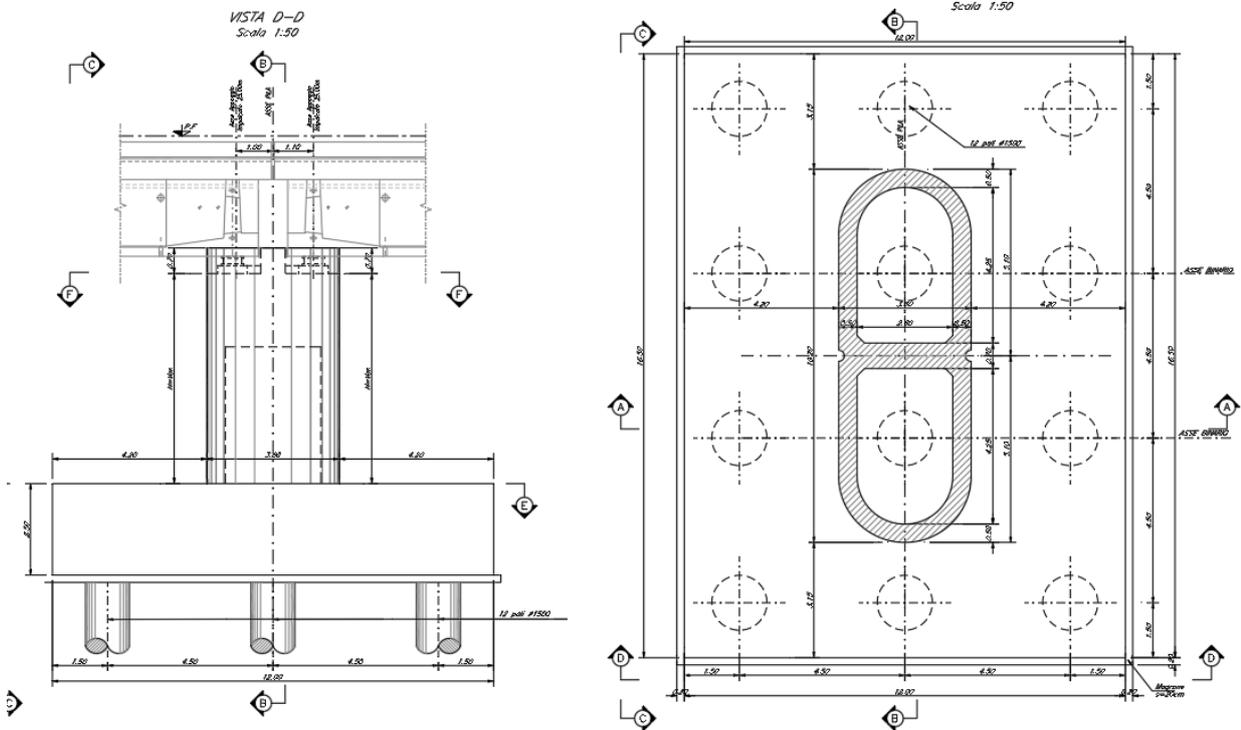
stralcio della carpenteria pila e fondazione su n°12 pali
